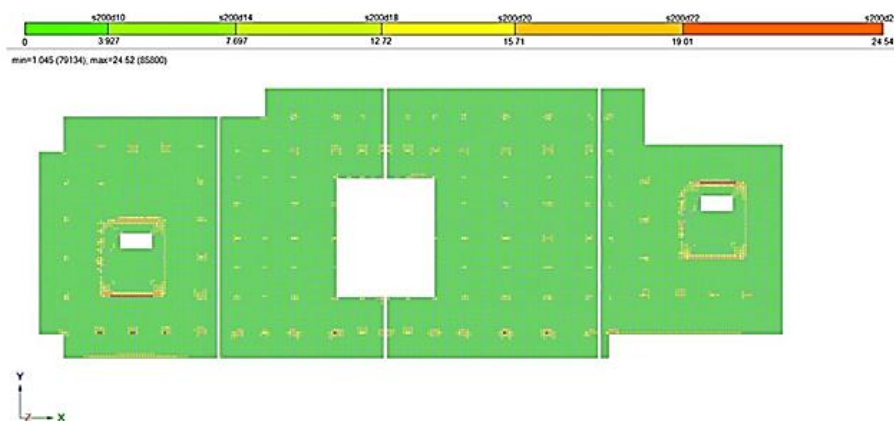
Підбір верхньої поздовжньої арматури вздовж осі Y
